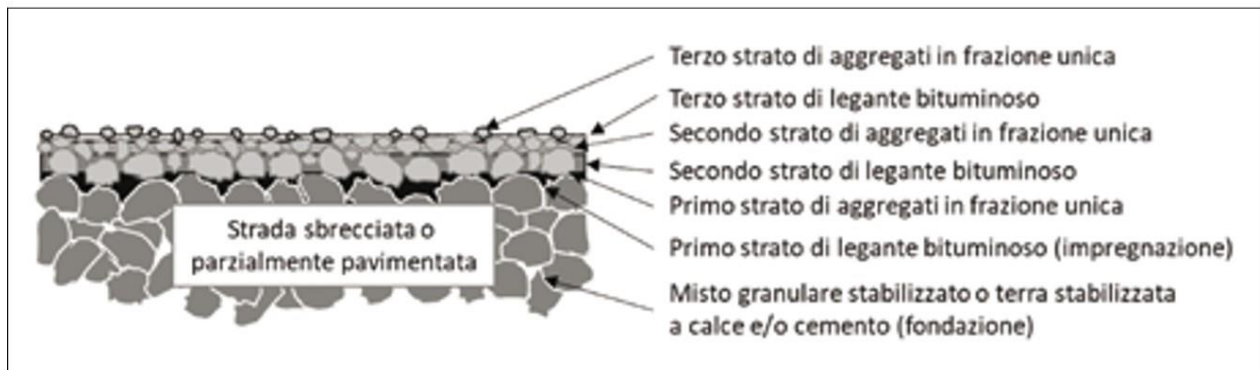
Schema tipico di un intervento di depolverizzazione a tre strati.
